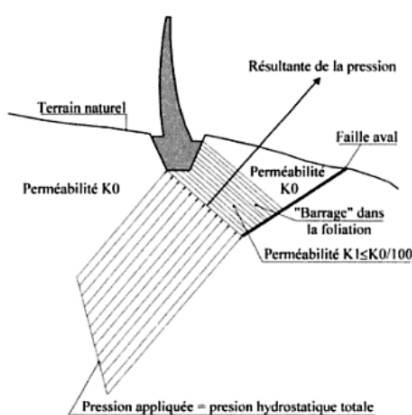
Pressions dans la fondation du barrage de Malpasset⁽¹⁾
